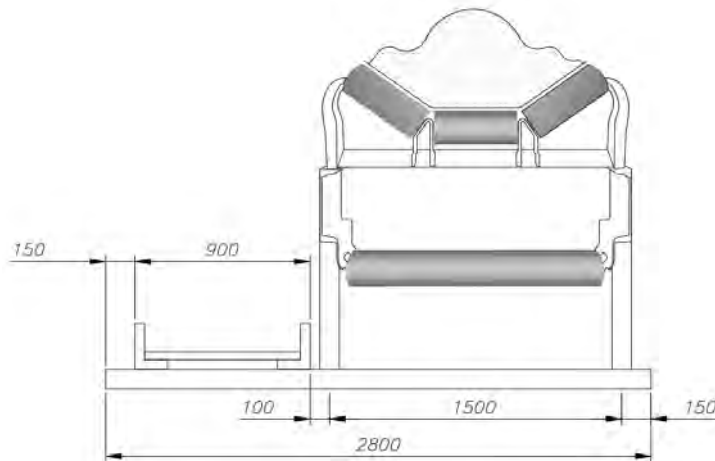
Configuración de viga de las cargas que soporta la viga de piso, medidas en mm.
